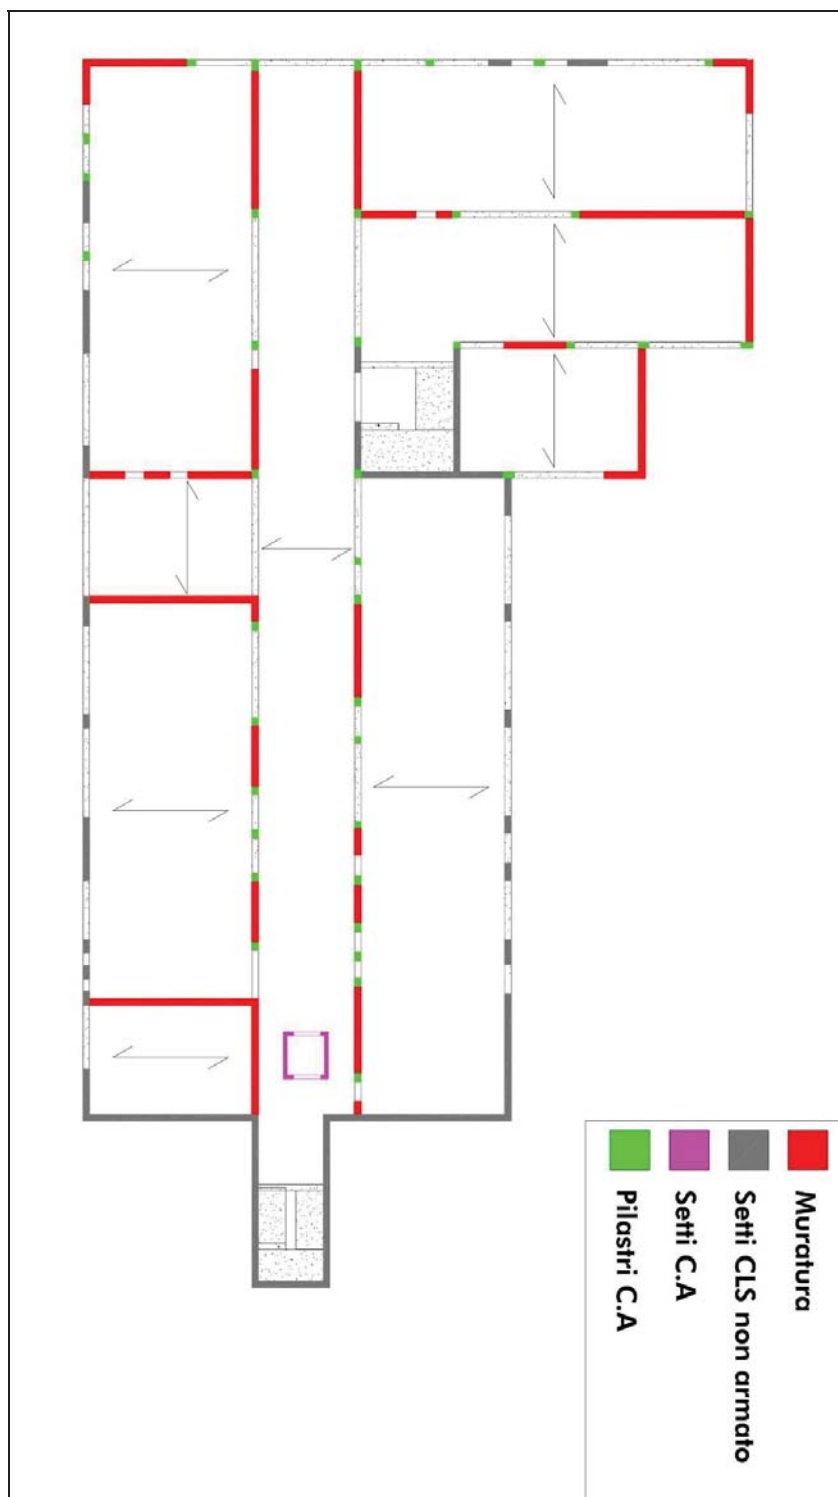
Pianta dei maschi murari, dei setti e dei pilastri del piano terra
